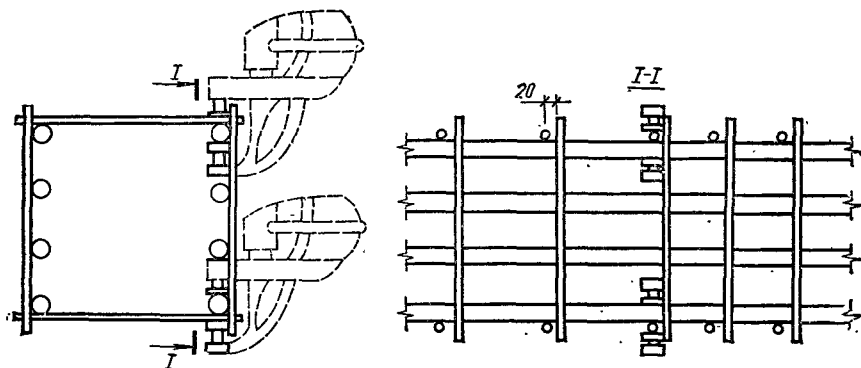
Положение сварочных клещей при сварке каркаса.
